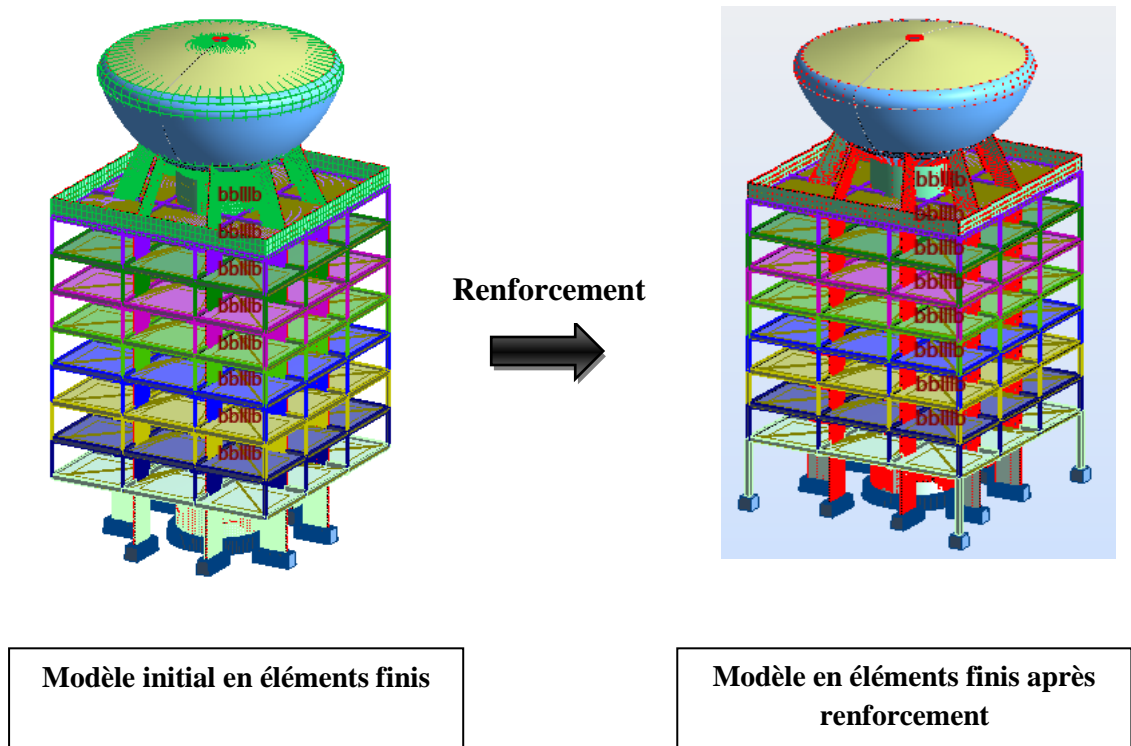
Renforcement par ajout d'éléments structuraux (poteaux)
